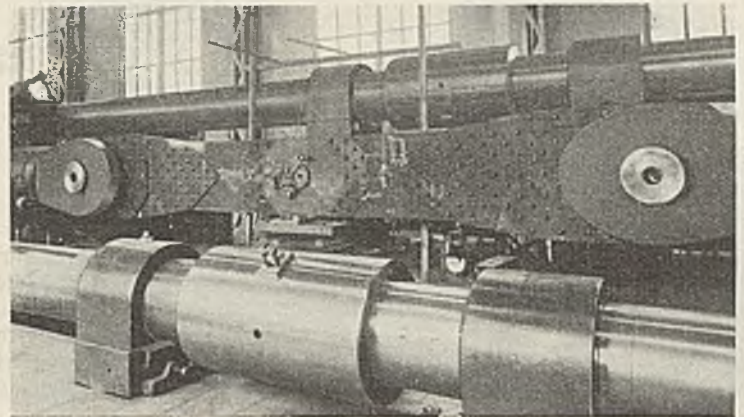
Versuchstück in der Universalmaschine. (Neben dem Augenbolzen Dehnungsfineßmesser.)
